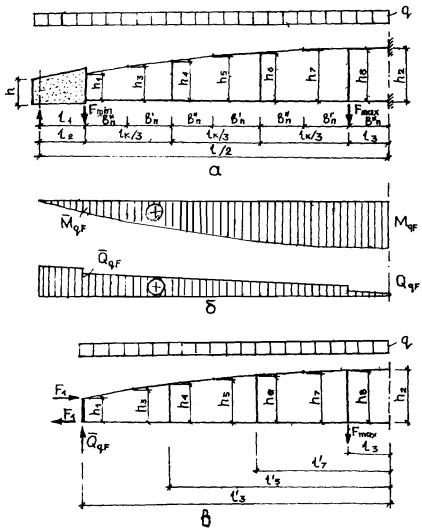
К построению расчетной схемы фермы днафрагмы по предельным состояниям аторой группы аграсчетная схема с использованием пластинчато-стержневой анпроксимации; 6-эпюры балочных усилин; в-расчетная схема с приманением стержневой эппроксимации
